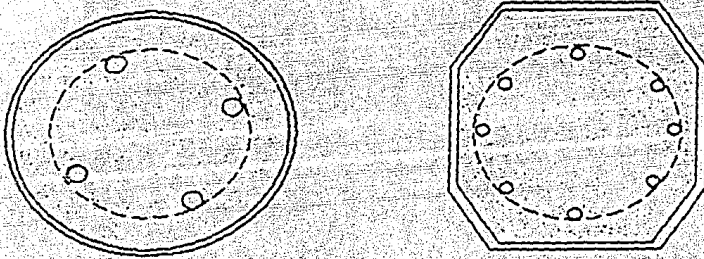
SECCIONES DE ACERO CERRADAS RELLENAS DE CONCRETO REFORZADO
